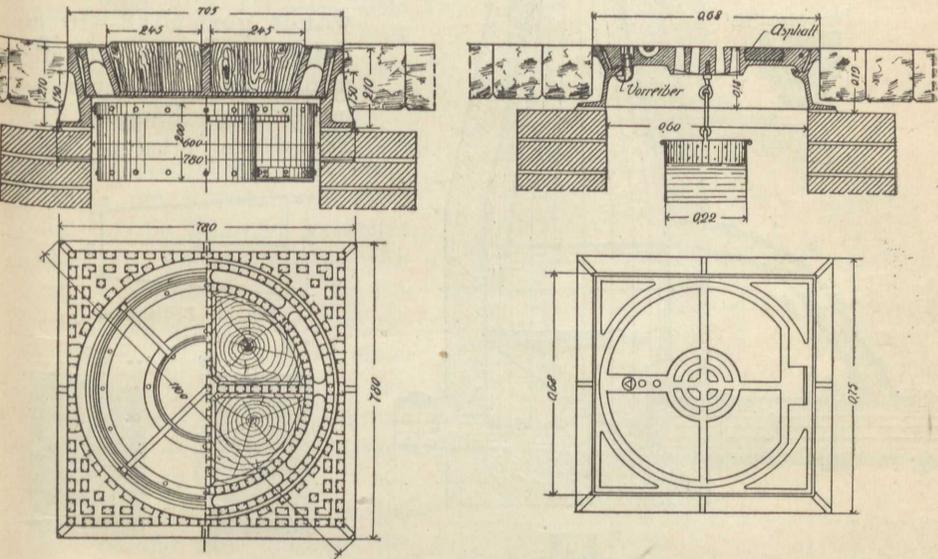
Schachtabdeckung mit Holzklötzfüllung.
